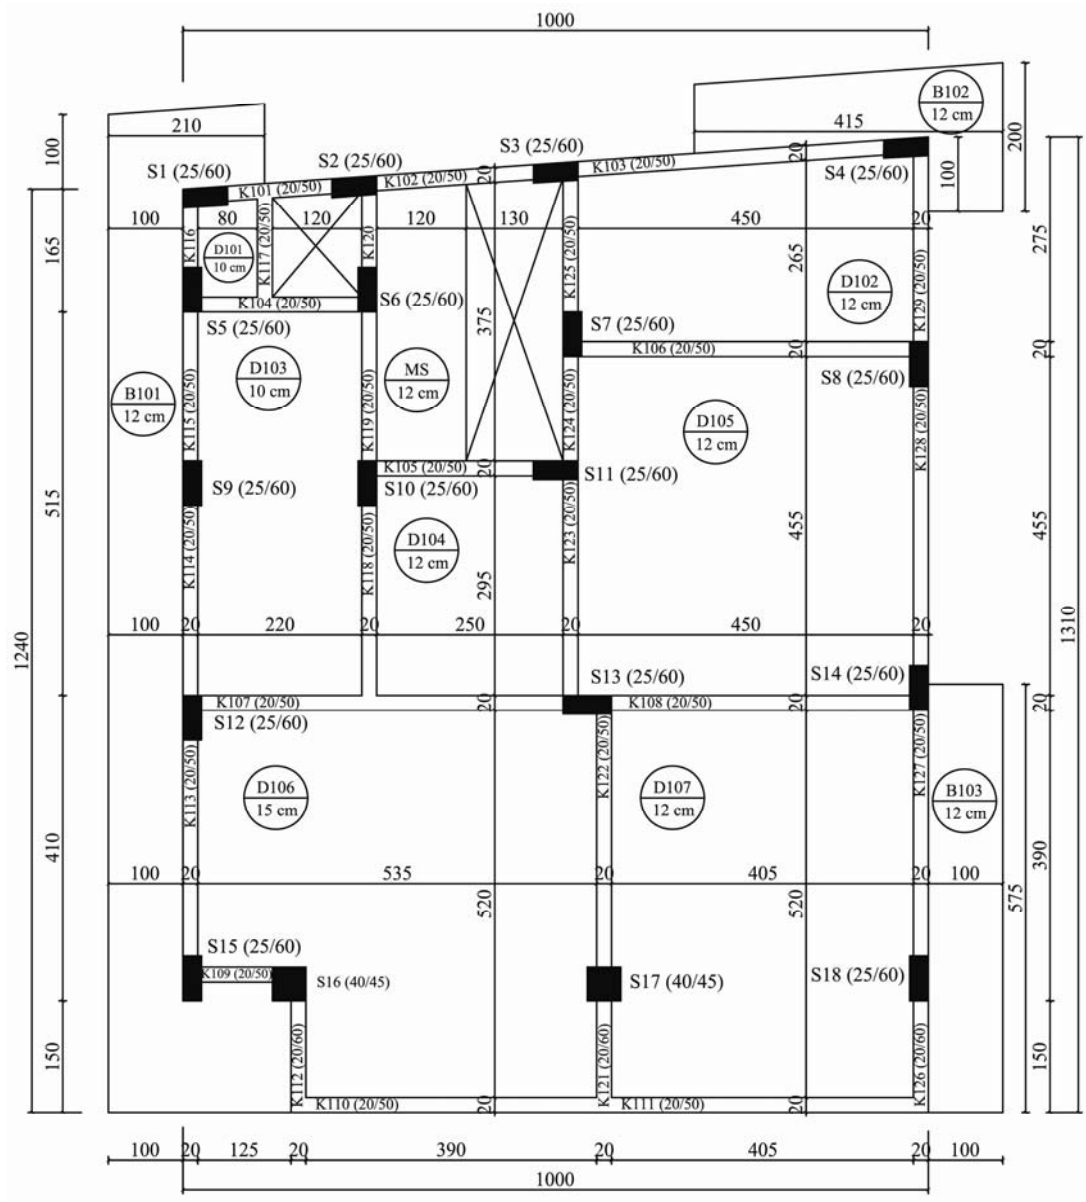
B5\_5'in kat kalıp planı
